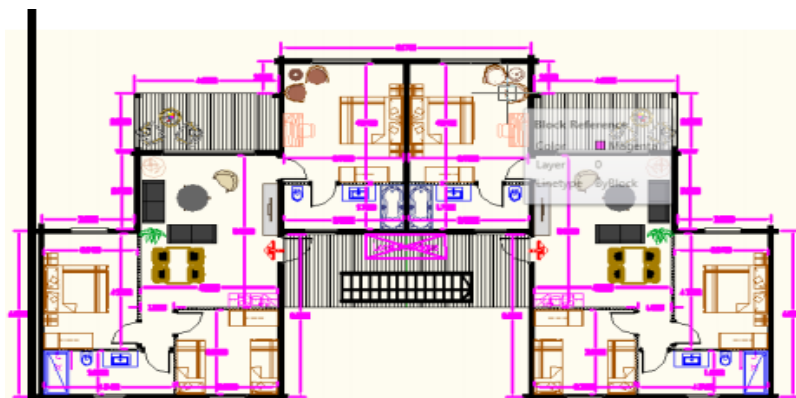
Plan du bloc villa VIP,source :direction de tourisme.
